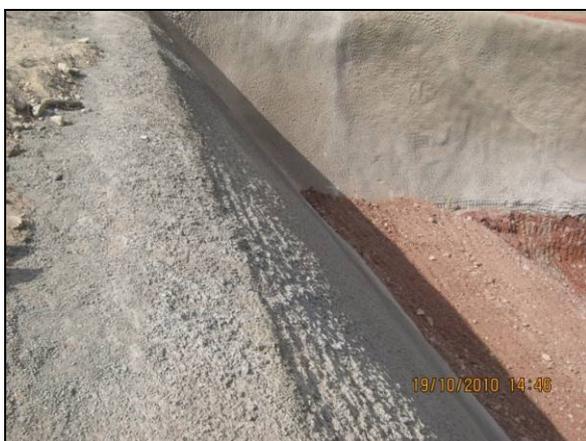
Contenção de talude por meio do uso de concreto projetado (out/10).
